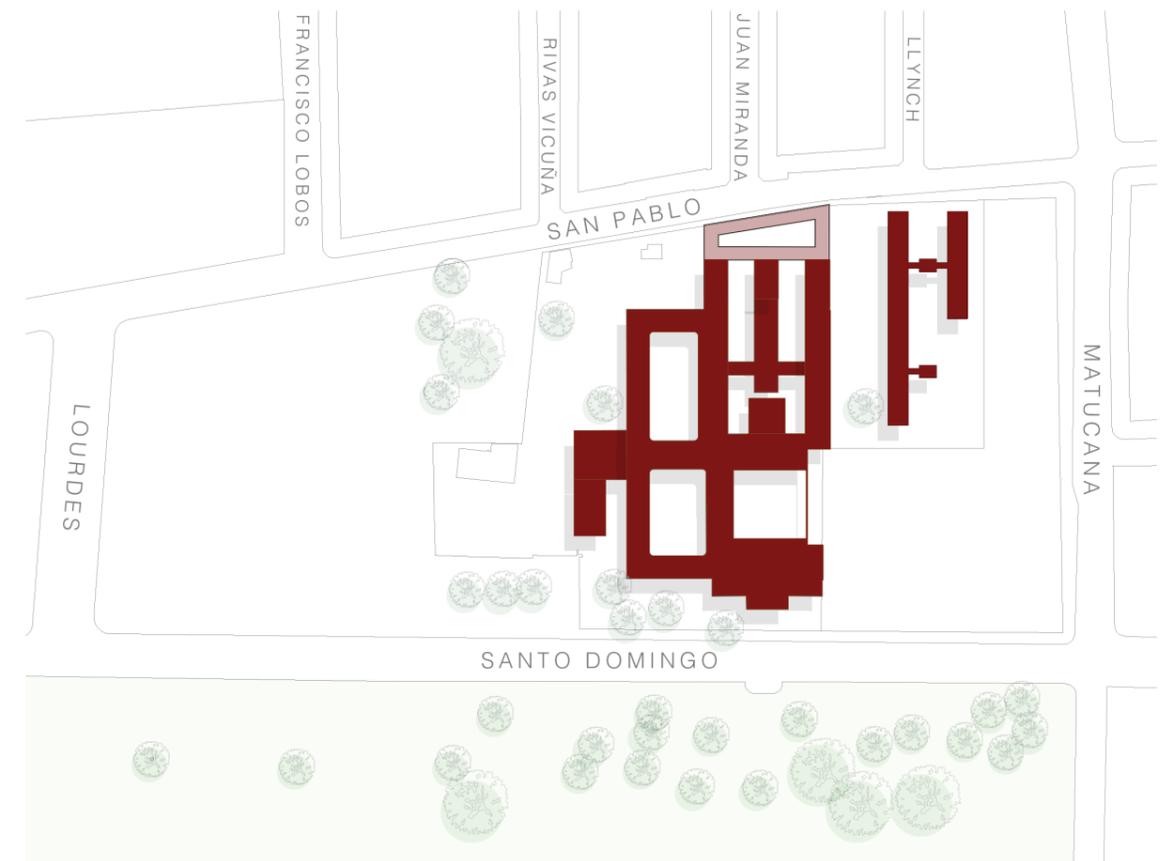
Planta de emplazamiento INBA. Elaboración propia.
